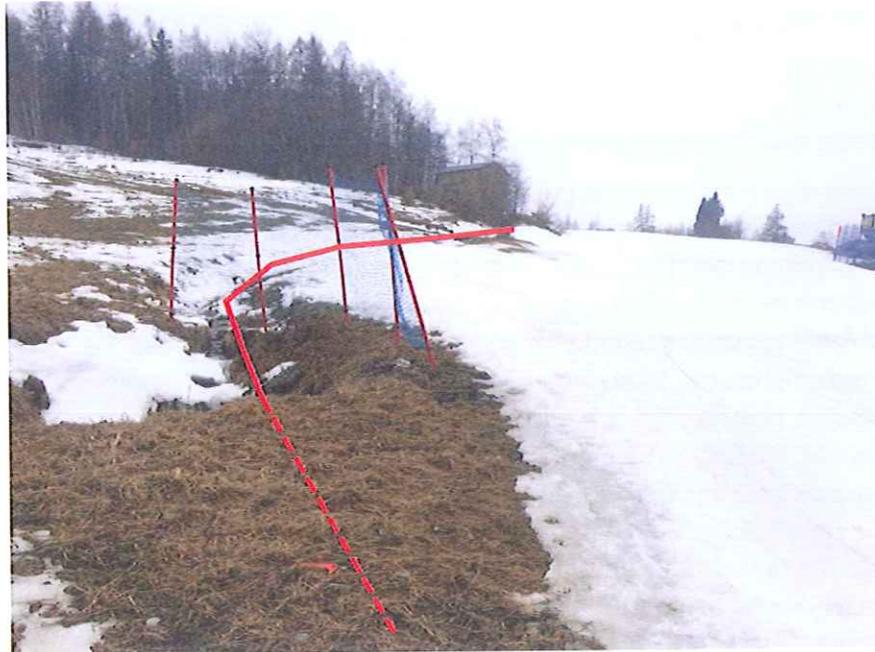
alveo naturale a monte del tratto tombato in corrispondenza dell'attraversamento della pista da sci di q. 1165 m slm
